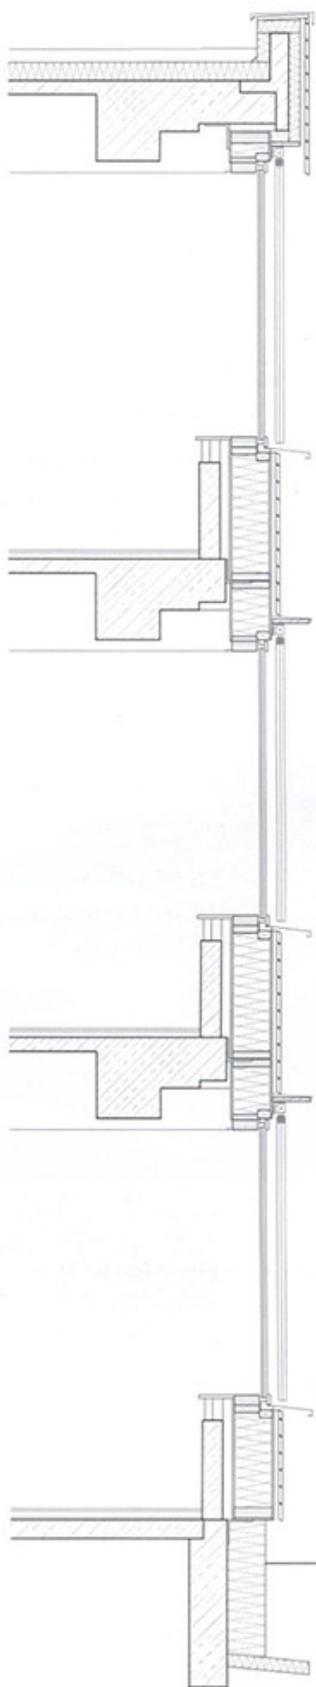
Detailschnitt Fassade mit neuer, vorgefertigter Hülle aus großformatigen Holzelementen
